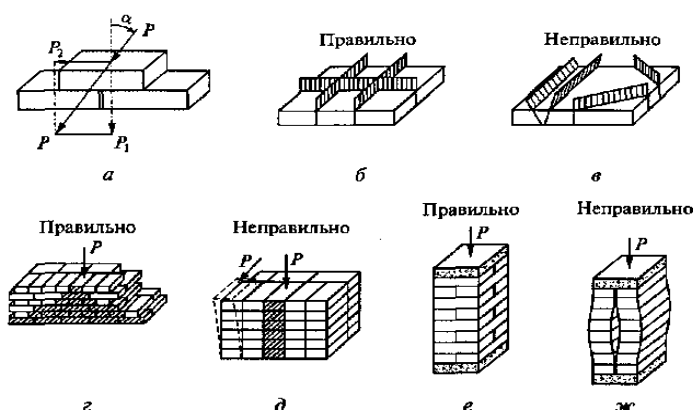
Схемы к правилам разрезки кладки: а — воздействие на кладку наклонной силы; б, в — членение рядов кладки на камни; г, е — кладка с перевязкой вертикальных швов; д, ж — кладка без перевязки швов.
